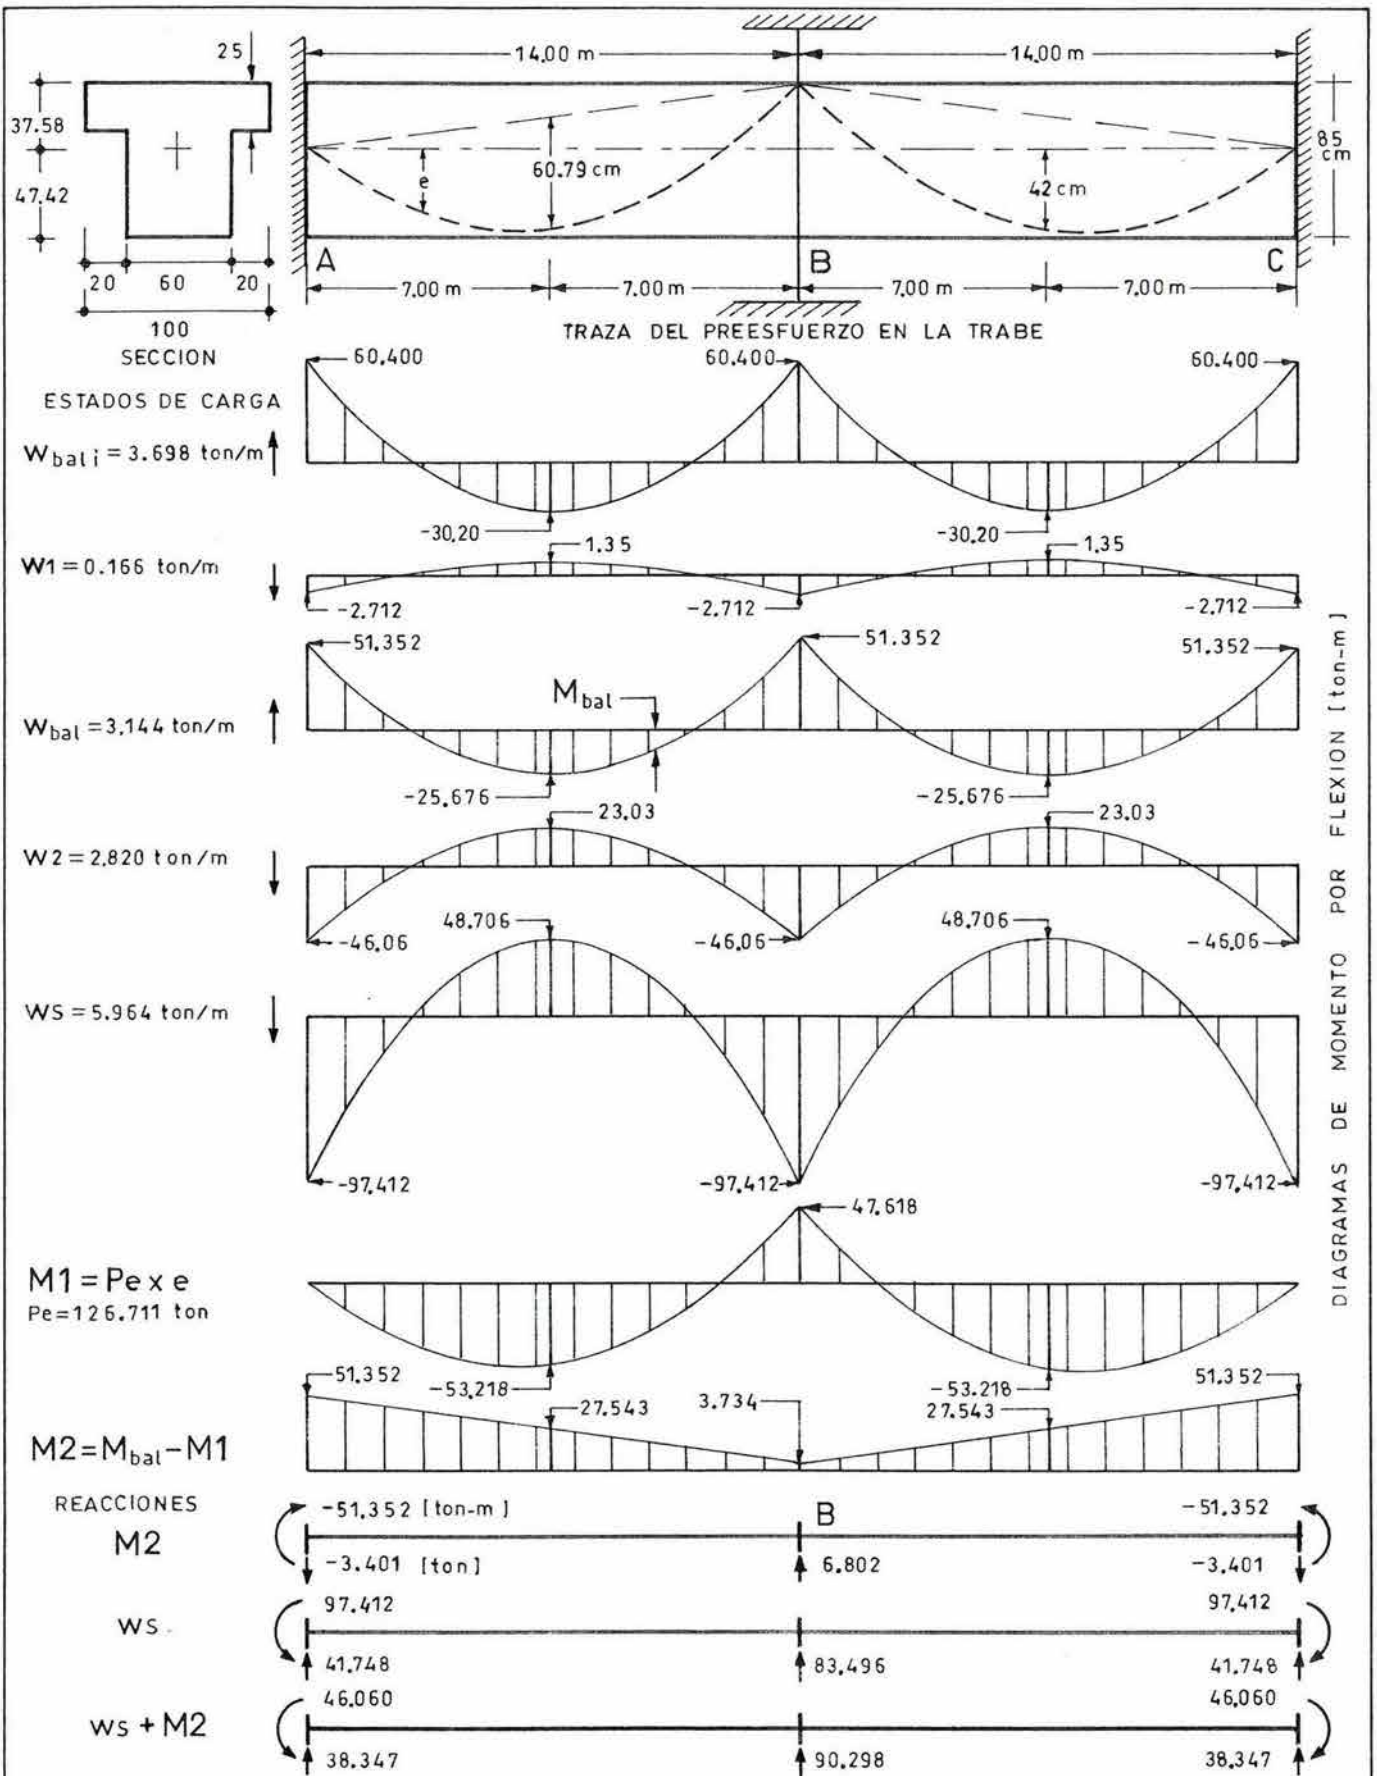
COMPORTAMIENTO EN FLEXION DE UNA TRABE DE CONCRETO PREESFORZADO ESTATICAMENTE INDETERMINADA
